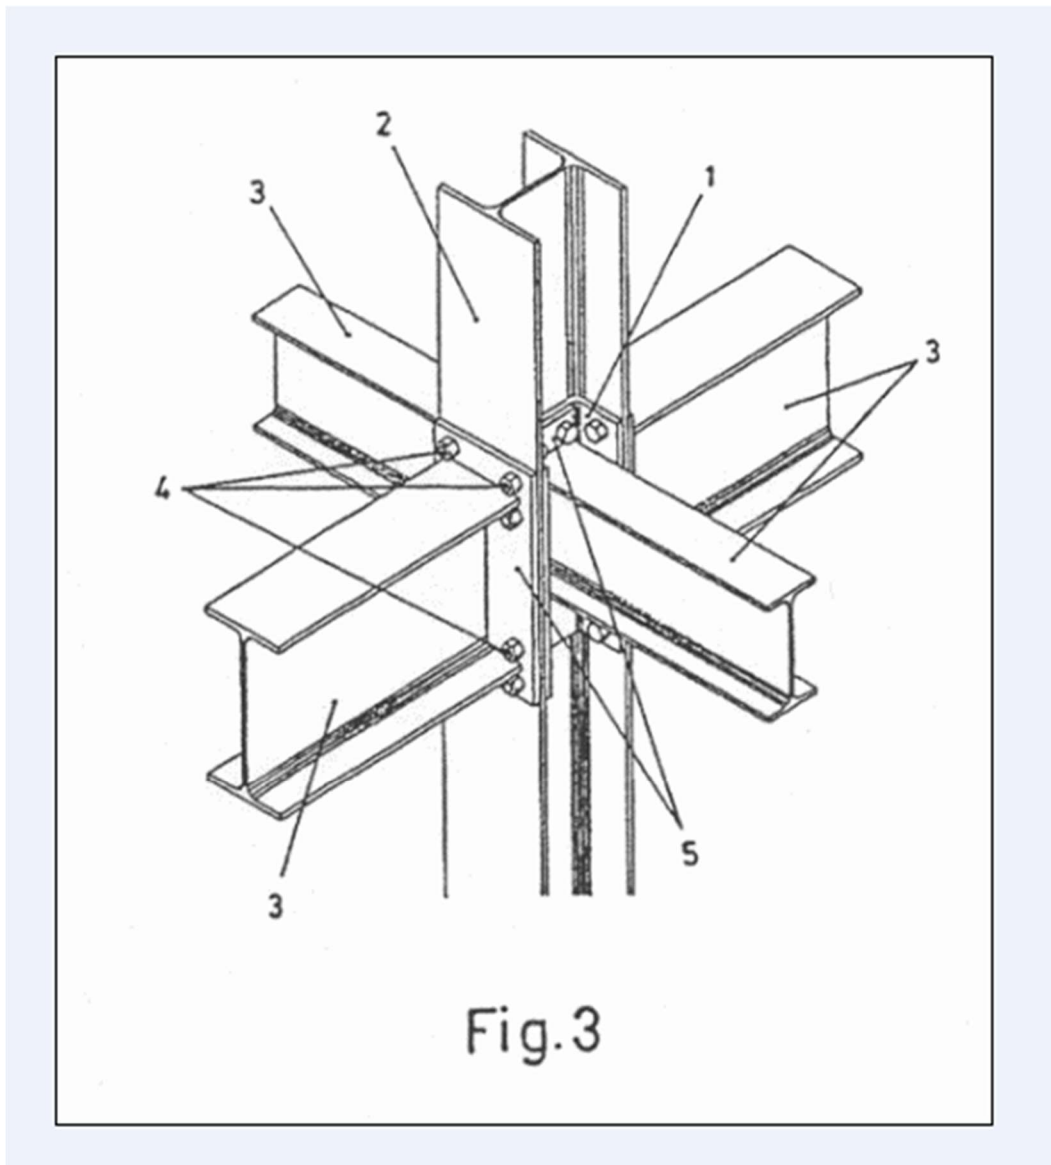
Detalle de fijación con pernos entre vigas y columnas
